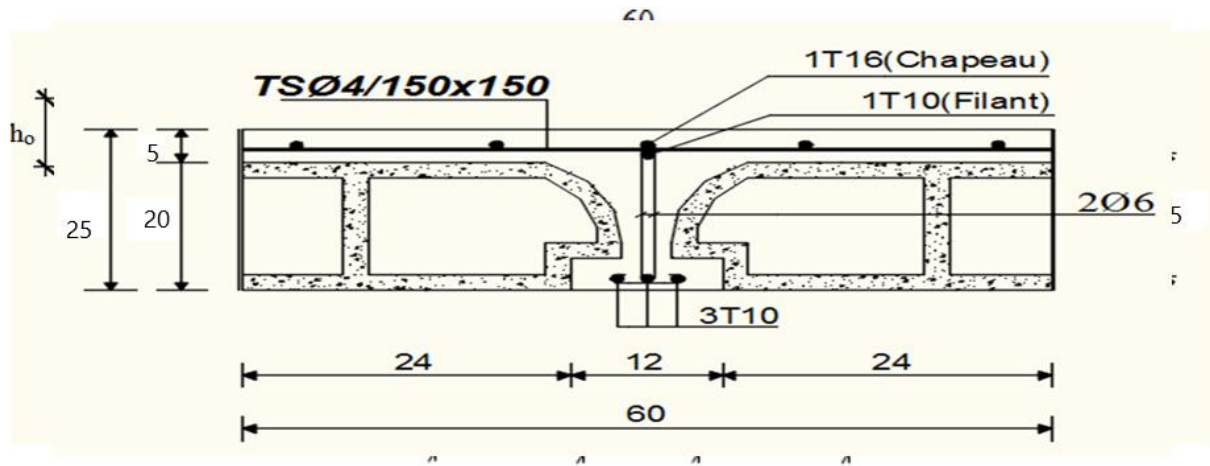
Coupe transversale d'un plancher à corps creux.
